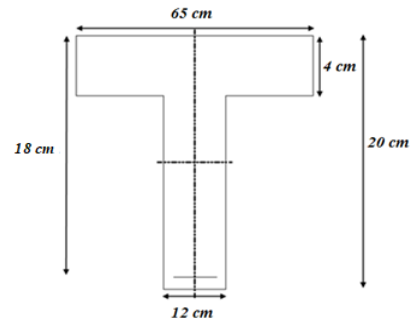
Section de la poutrelle après coulage de la dalle de compression.
